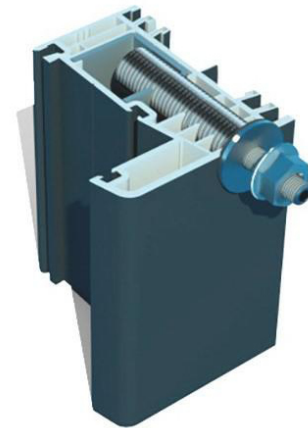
Fensteranschluss Brüstung und Entweichungsschutz
